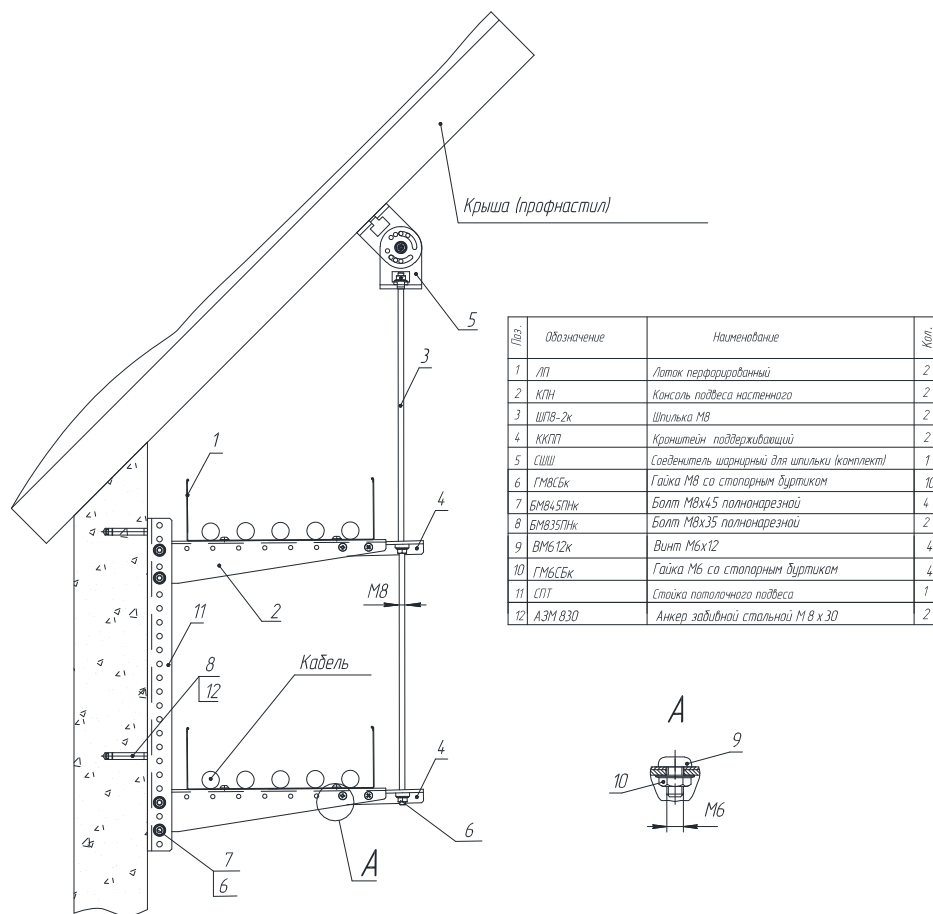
Крепление ОКЛ под углом к металлоконструкции (профнастилу) с помощью шарнирного соединителя СШШ
